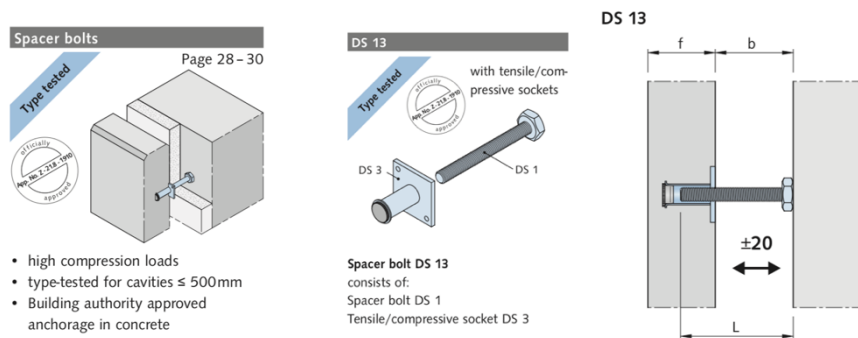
Modo e material de fixação dos painéis pré-fabricados de betão, HALFEN
